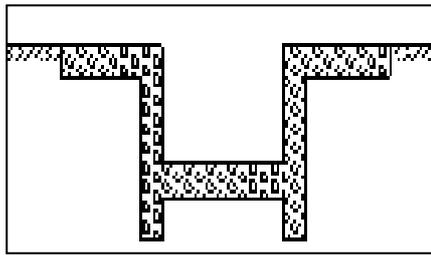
Drainase Trapesium Saluran Batu Kali / Cor Plat Beton.
